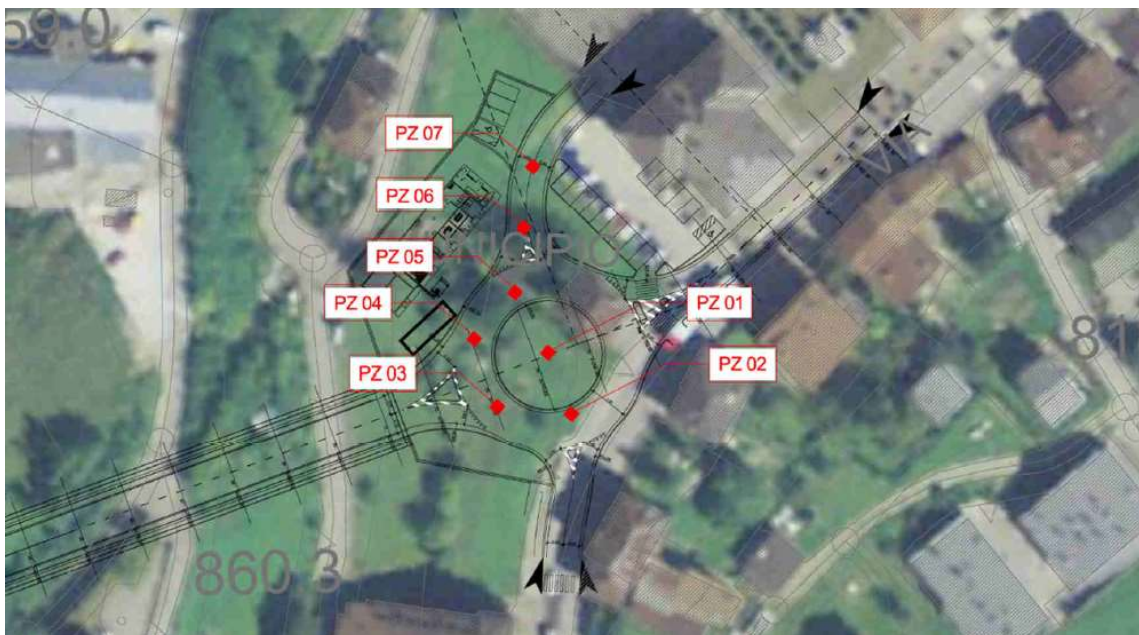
Svincolo EST ortofoto: localizzazione dei saggi rispetto al tracciato
